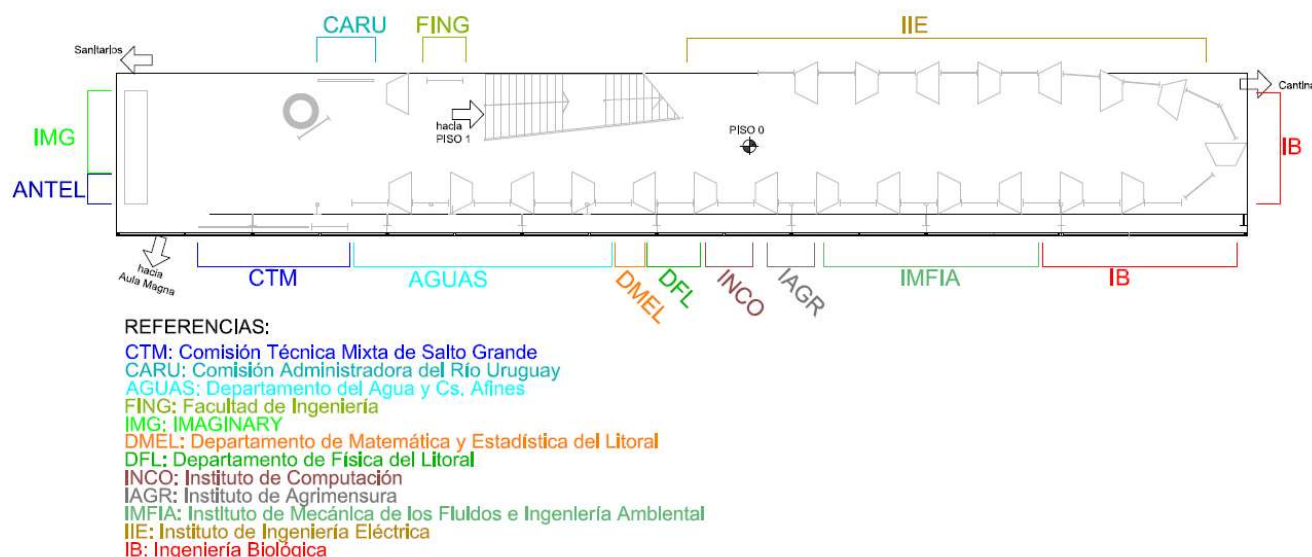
Planta piso 0 con distribución de los espacios de muestra
